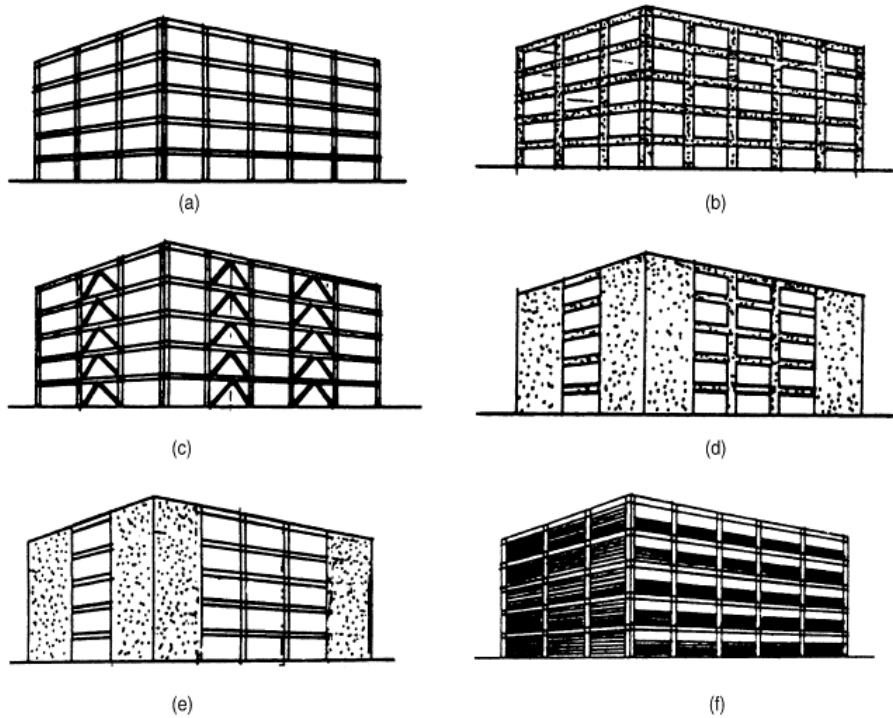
Sistemas estructurales de rigidez lateral (a) Pórticos de acero, (b) Pórticos de concreto reforzado, (c) Pórticos arriostrados de acero, (d) Muros estructurales de concreto, (e) Pórticos de acero con muros de concreto, (f) Pórticos de acero con muros de albañilería no reforzada. (Taranath, 2005)
